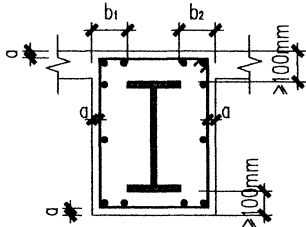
型钢混凝土梁型钢及钢筋保护层要求
